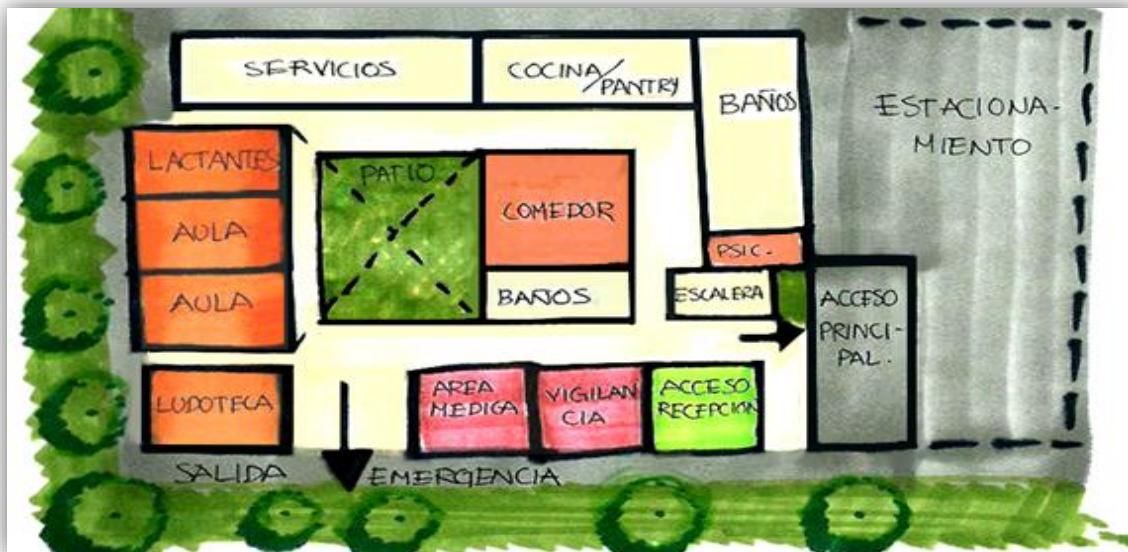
Imagen de partido arquitectónico, planta baja. Acervo personal
